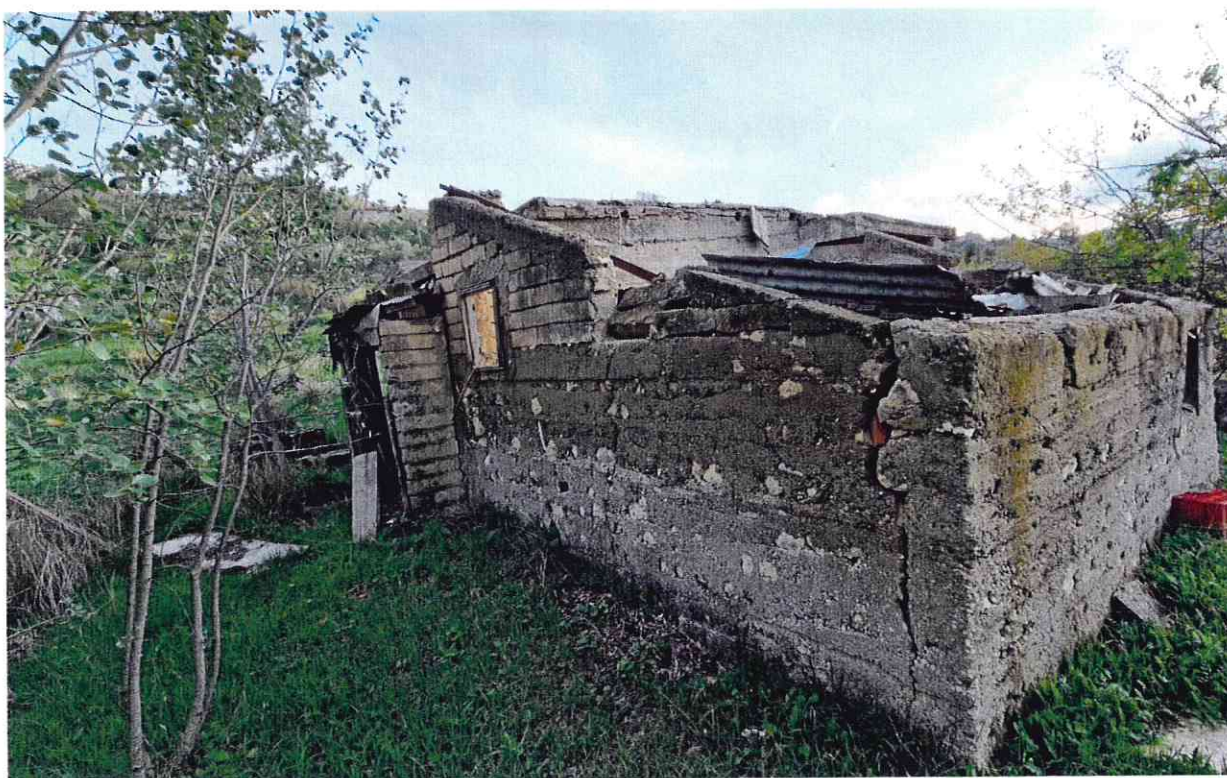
(PARTICOLARE DEL DISSESTO DEL FABBRICATO)
